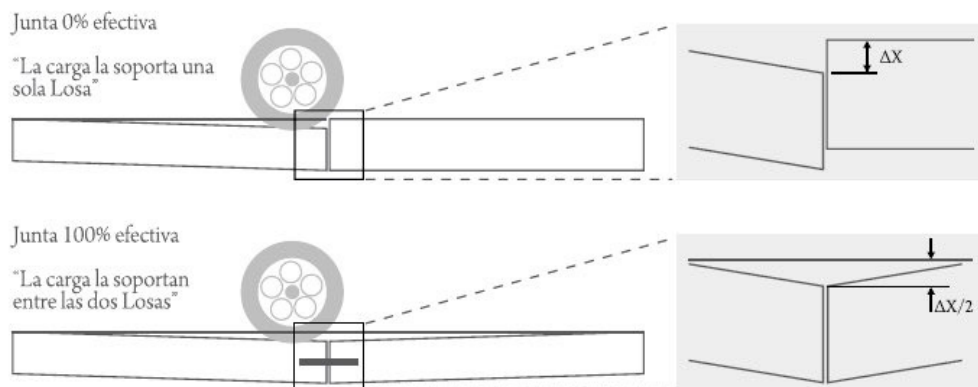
transferencia correcta e incorrecta entre lasas de pavimentos.
